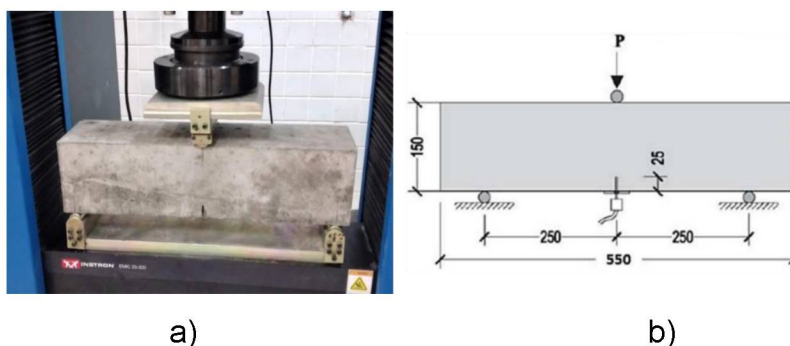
a) Corpo de prova do ensaio de tração e b) representação das dimensões
